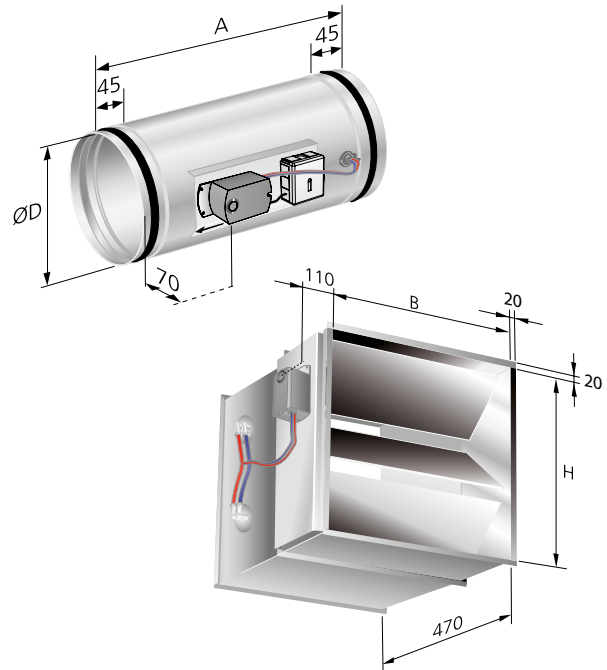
SLAVE Room, runde und rechteckige Ausführung. Rechteckige Klappen müssen immer mit waagerechten Achsen montiert werden.
